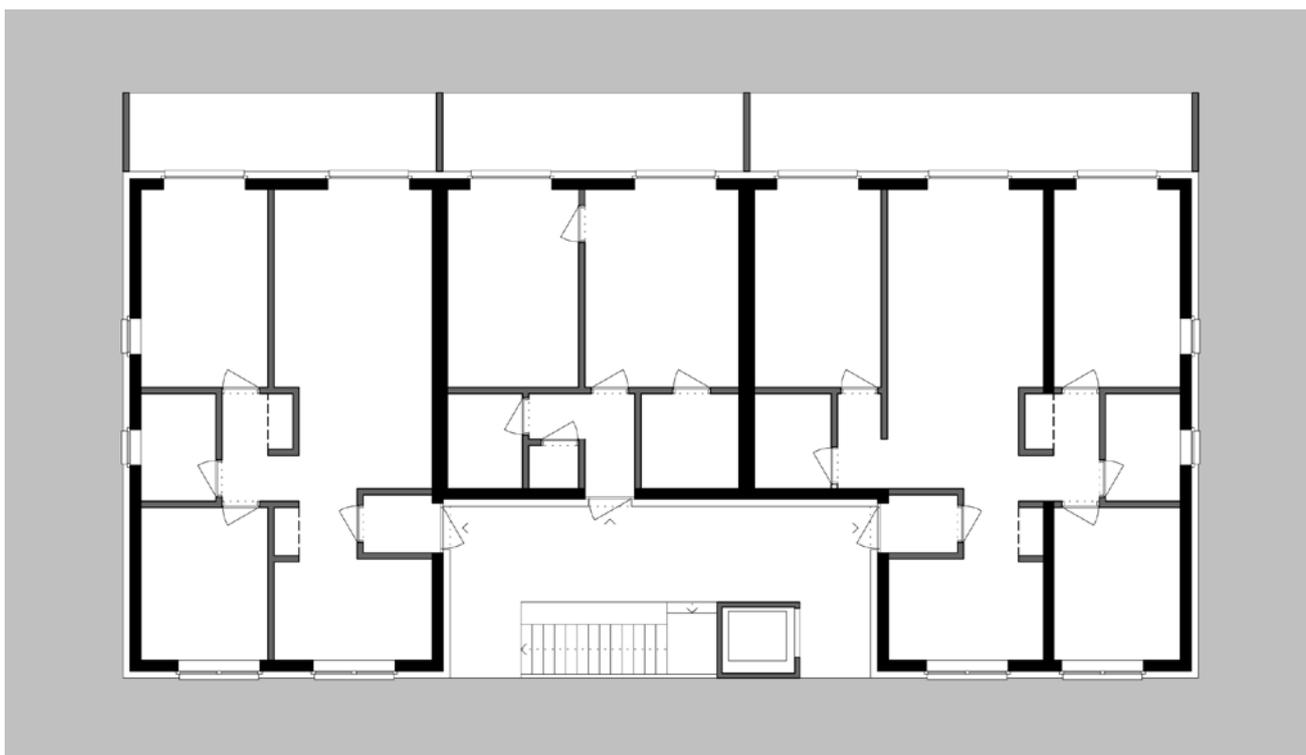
Referenzgebäudes Mehrfamilienhaus (MFH) mit zwei Stockwerken, dargestellt im Grundriss für Erdgeschoss und Obergeschoss
